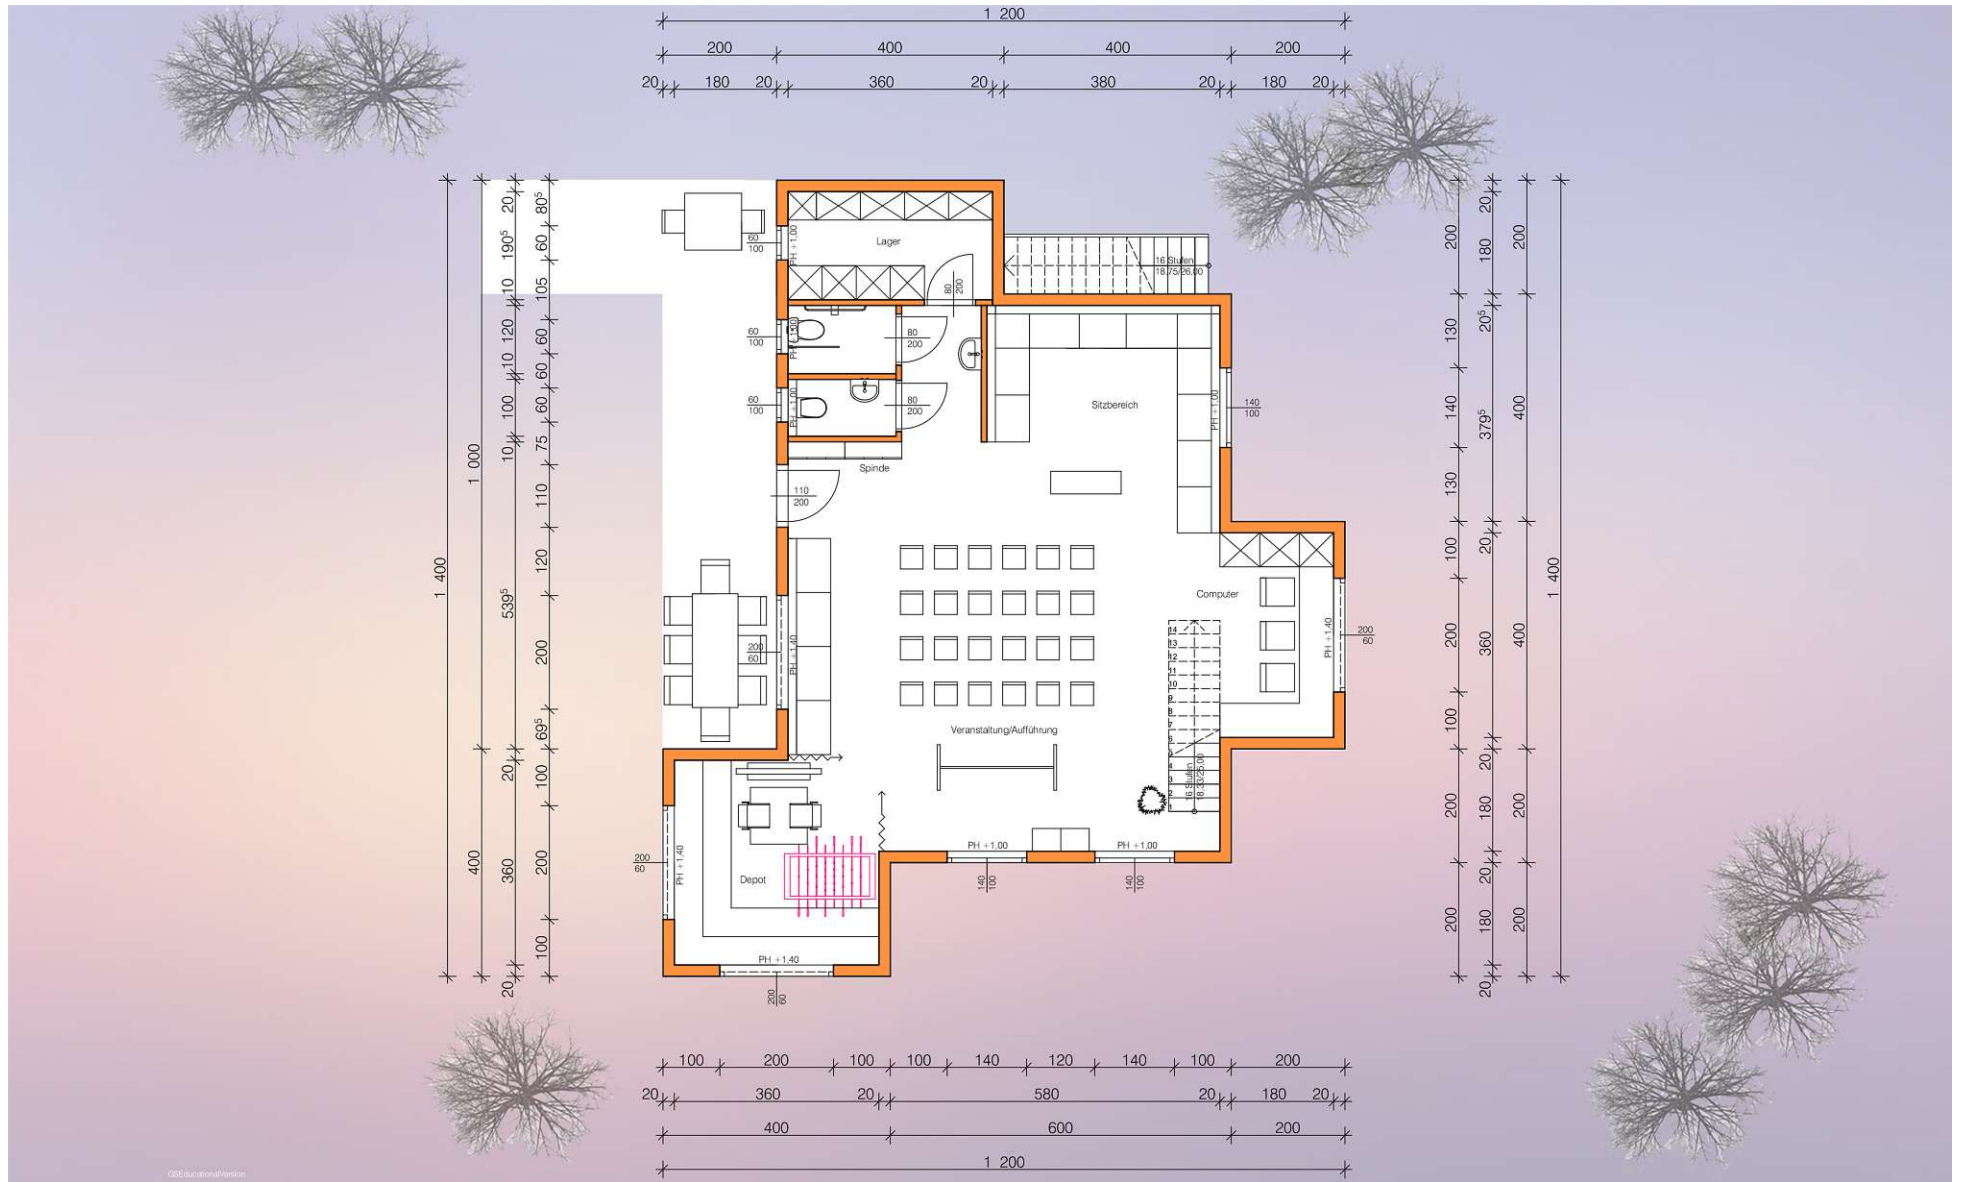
GRUNDRISS HAUS A- ALTERNATIV - ERDGESCHOSS 1:100
